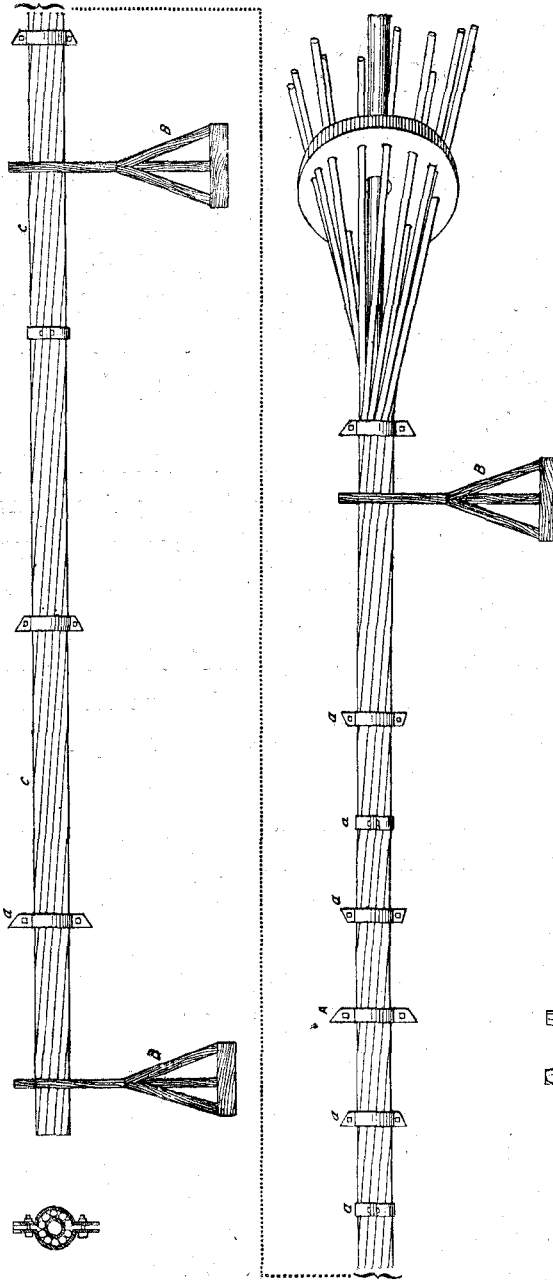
CONSTRUCCIÓN DEL CABLE.
